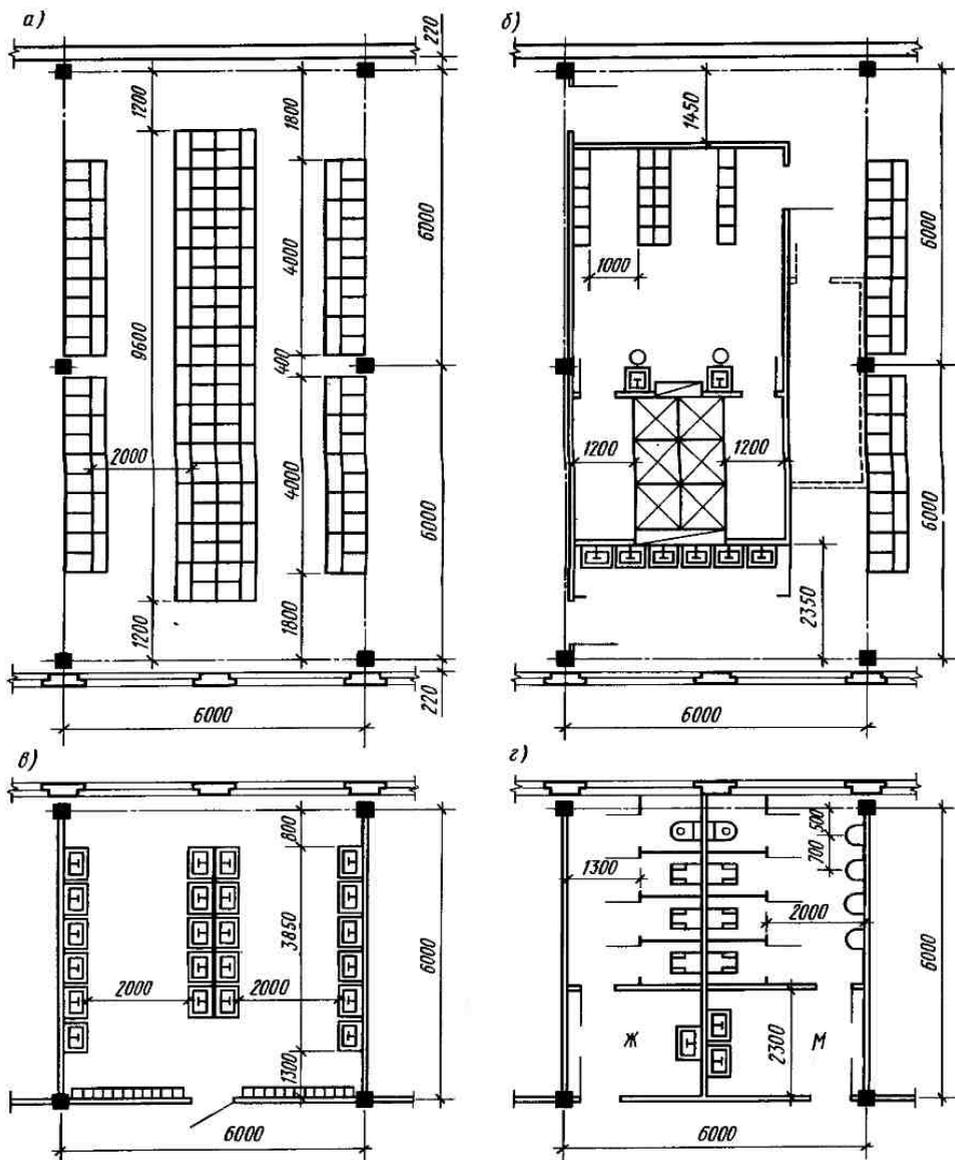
Примеры планировок отдельных бытовых помещений
